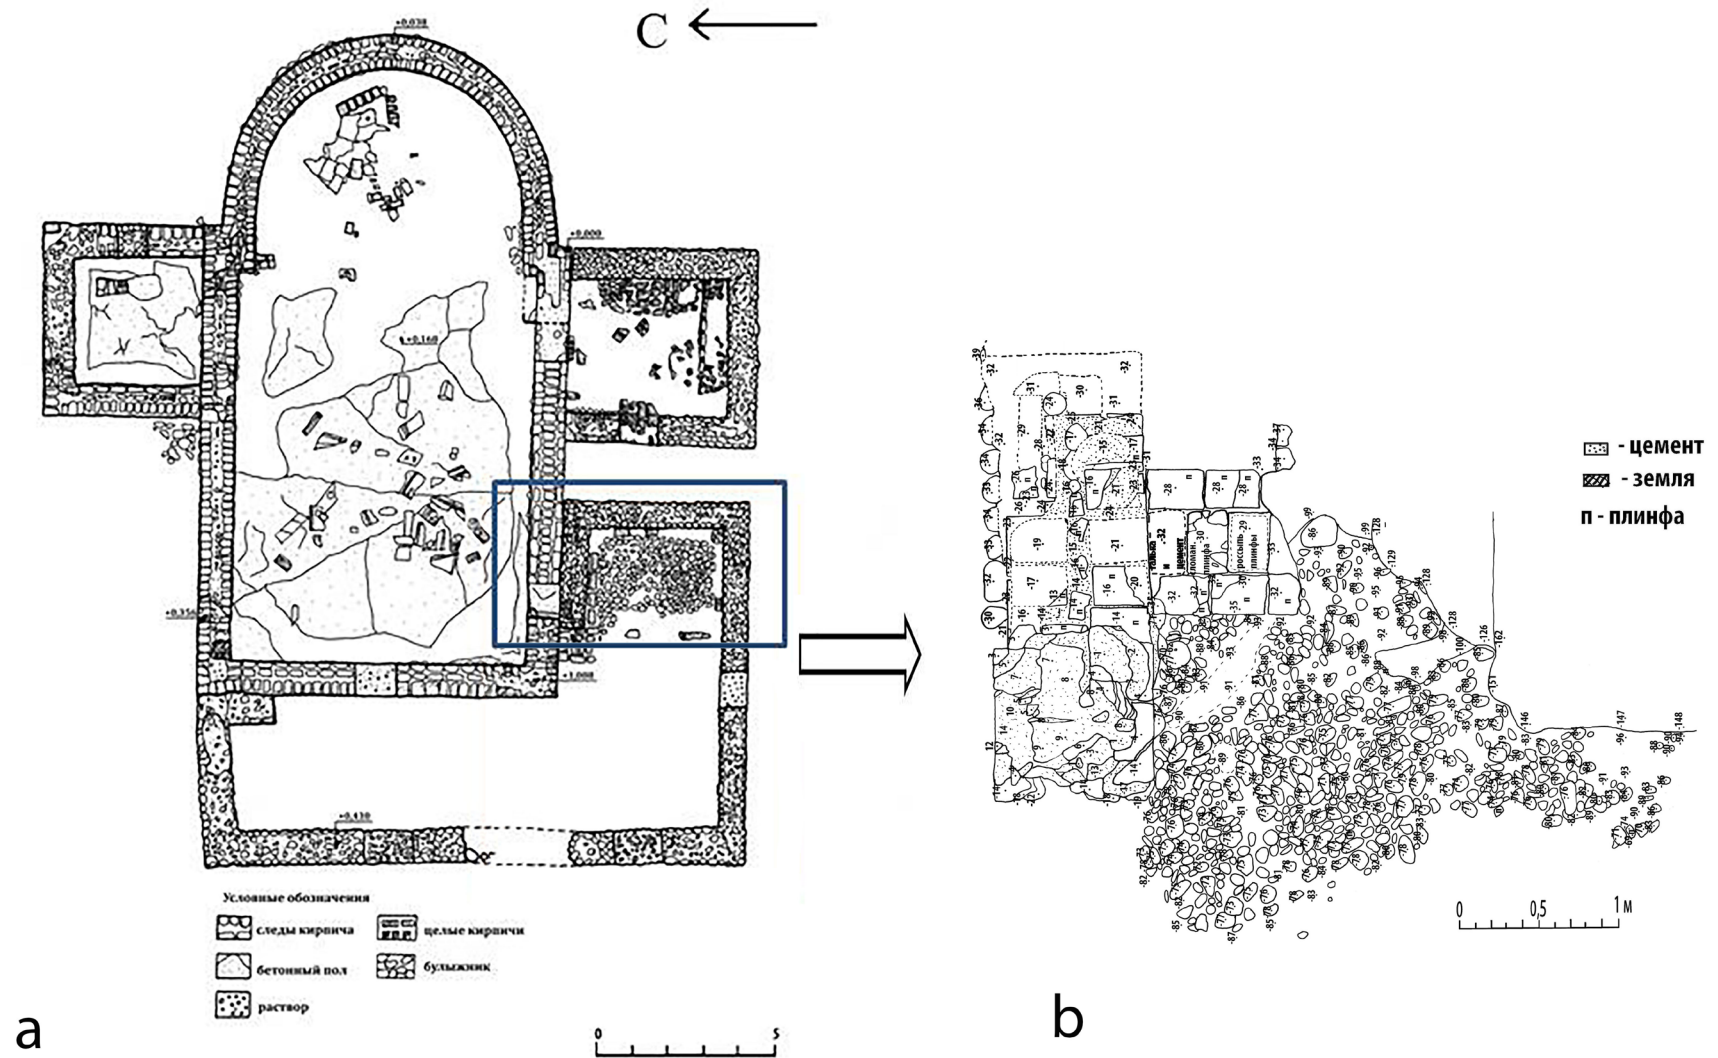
Храм на городище Гиенос: общий план с указанием места святилища (а) и план святилища со стенами наоса и нартекса храма
